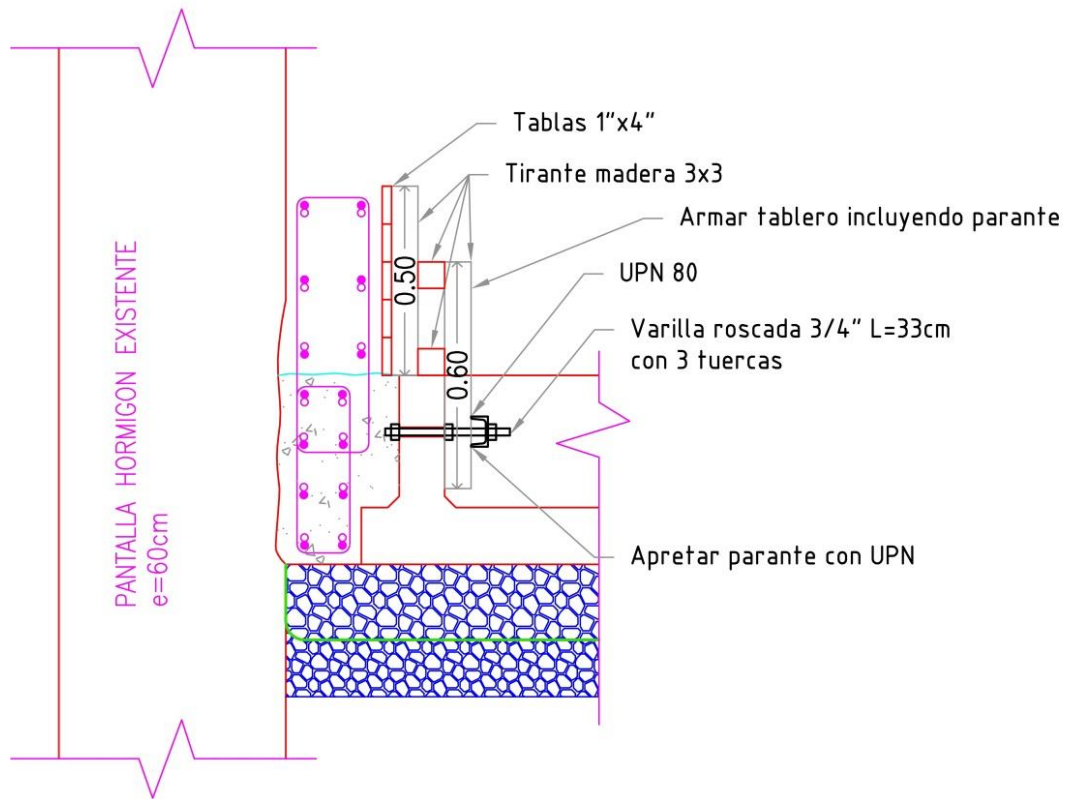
Encofrado 2da etapa hormigonado viga de fricción
